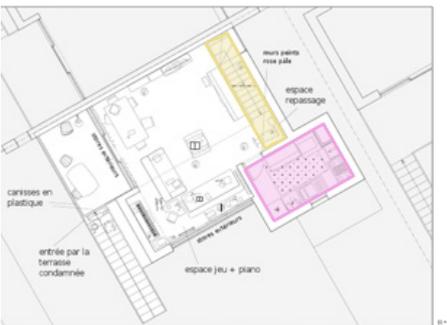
Planimetrías de Mul(ti) House, con la diferenciación por colores: azul cocinas, rosa baños, amarillo almacenaje y blanco resto.
